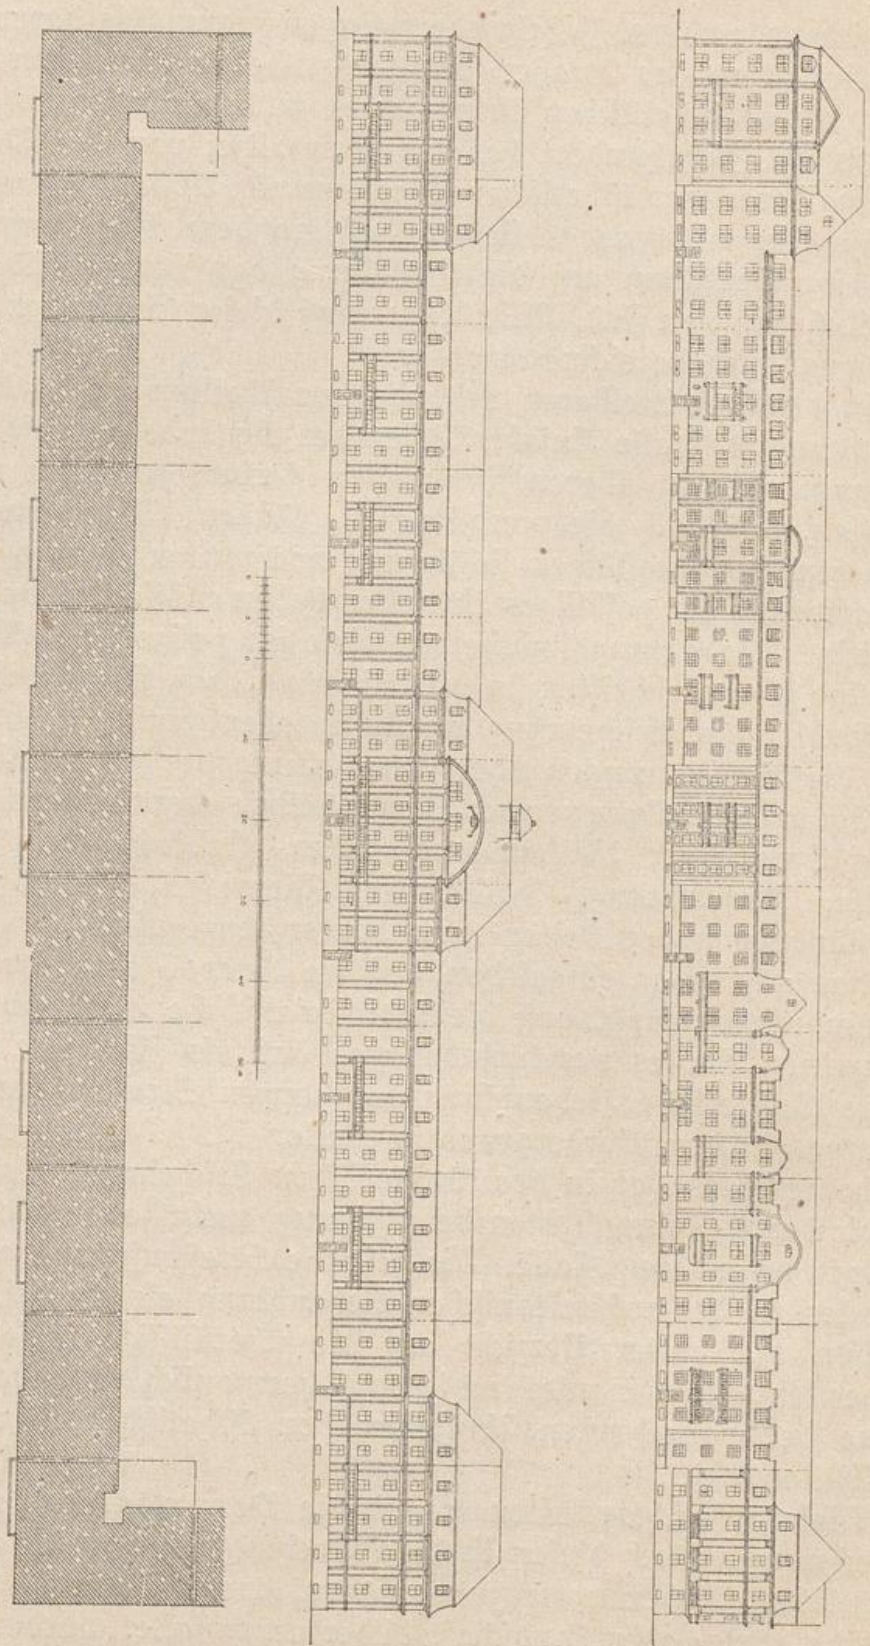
Baublockfassade mit Betonung des Einzelhauses.
